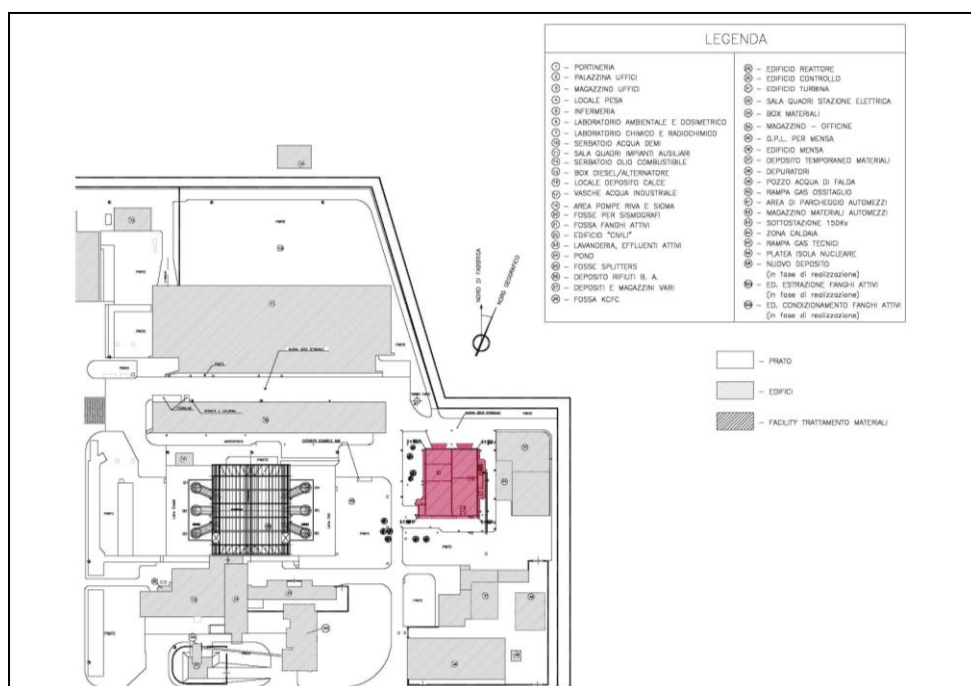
Ubicazione dell'Edificio della Facility all'interno dell'impianto.
